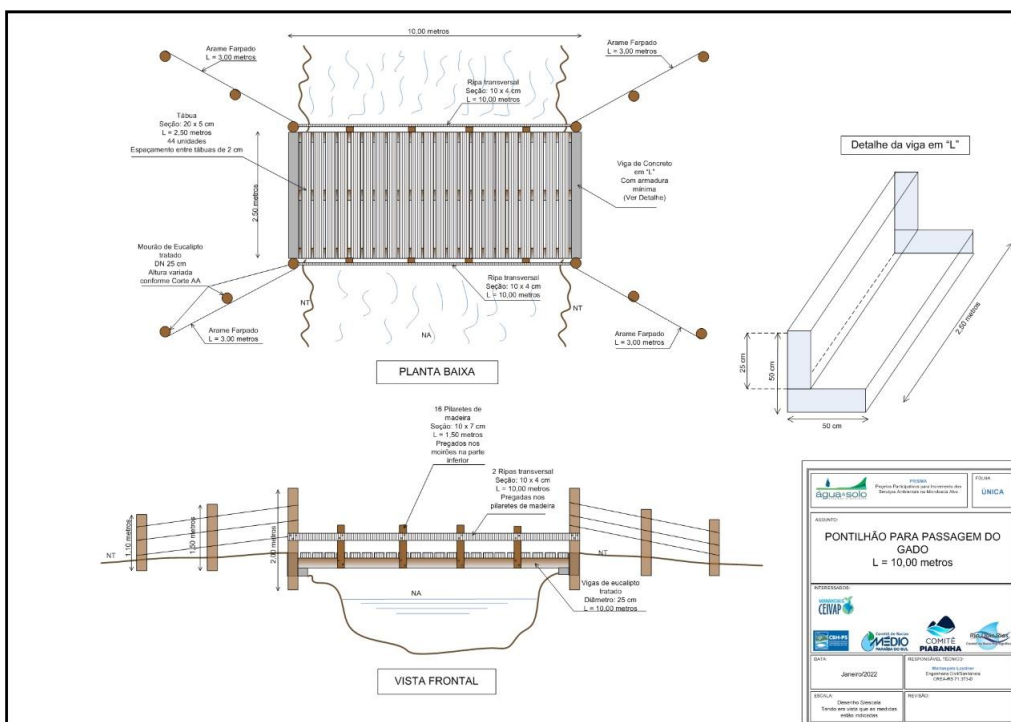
Planta baixa e vista frontal do pontilhão de 10X2,5m
